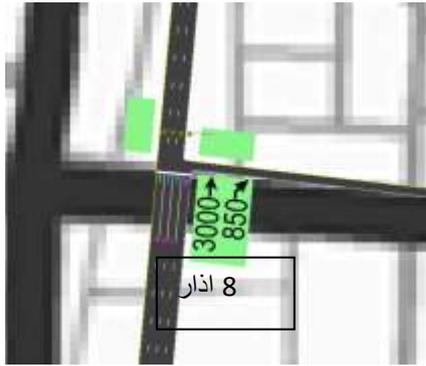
مسقط أفقي لتقاطع شارع المغرب العربي مع شارع 8 اذار
